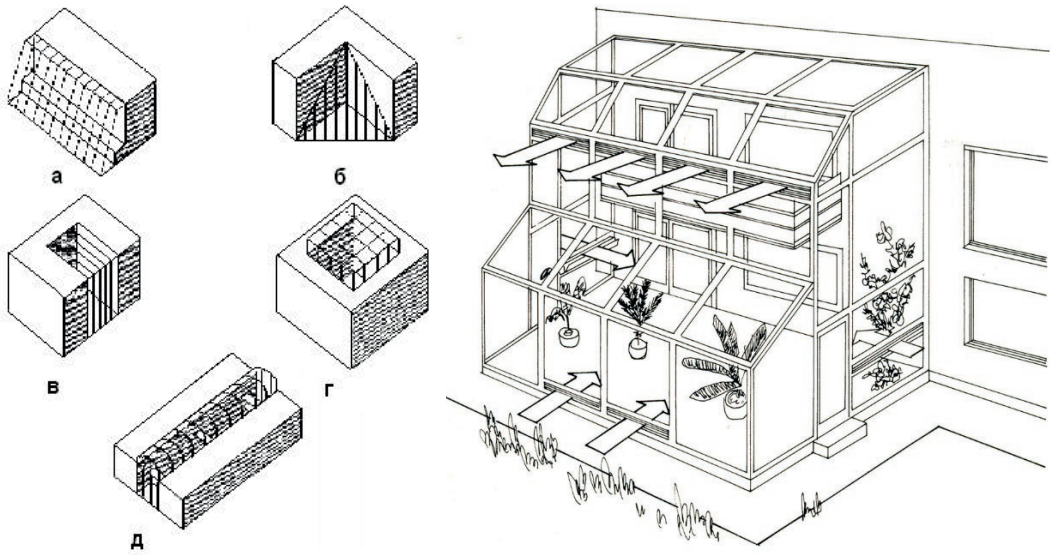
Прибудовані об'єми до існуючої будівлі
